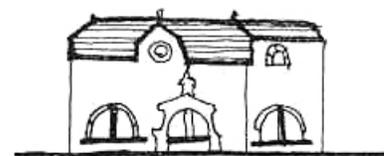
Vivienda Maisonette. Fachada frontal. La Otra Ciudad
